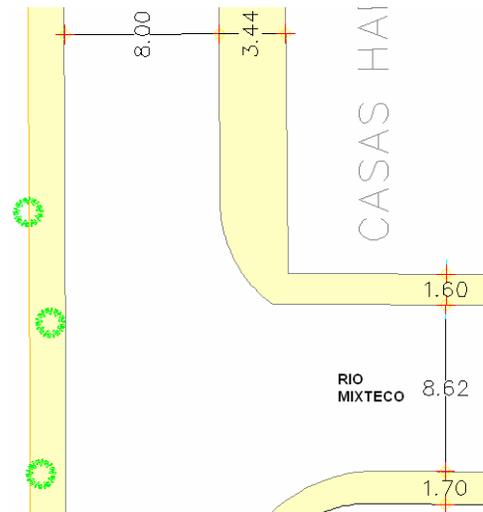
Calle Rio Mixteco. Arroyo vehicular 8.60m
